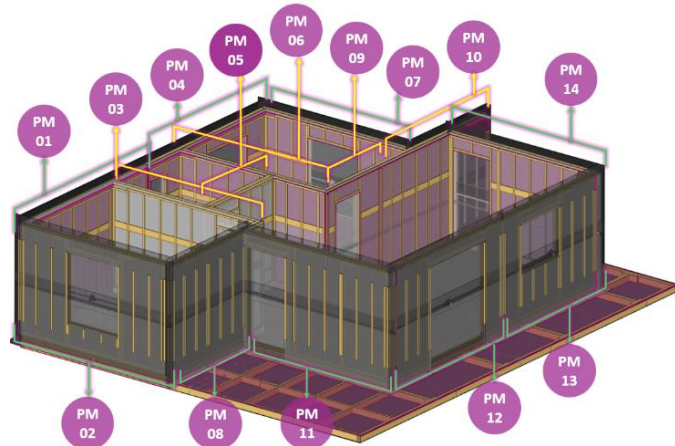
Paneles de muro. Adaptado de modelo Cadwork Proyecto 23BP-246692 (2024).
